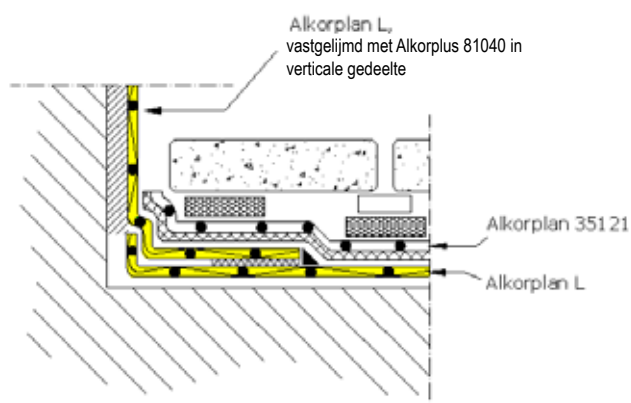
Alternatieve oplossing voor de bevestiging aan de rand met Alkorplan® L van 1,2 mm dik : ballastlaag met betontegels wanneer een mechanische bevestiging aan de rand niet mogelijk is
